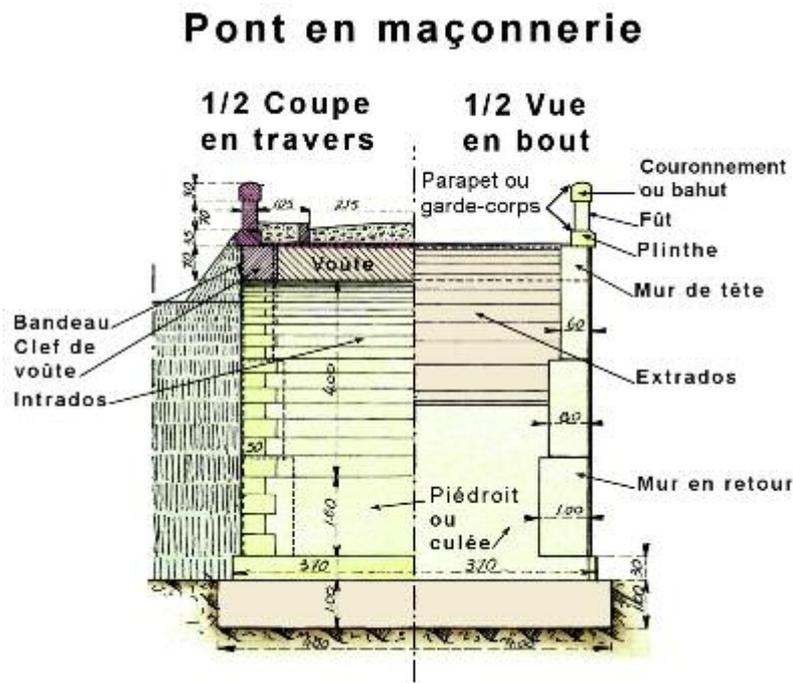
demi-coupe transversale et demi-vue en bout d'un pont en maçonnerie
